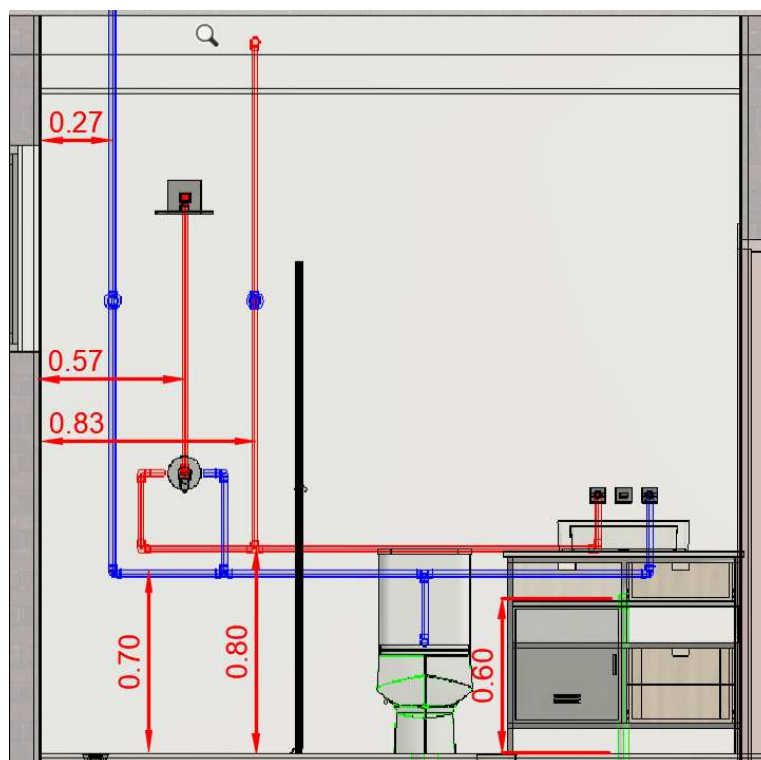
Instalações Hidrossanitárias Banho Suíte 3: Corte frontal com vista do lavatório, vaso sanitário e chuveiro.
